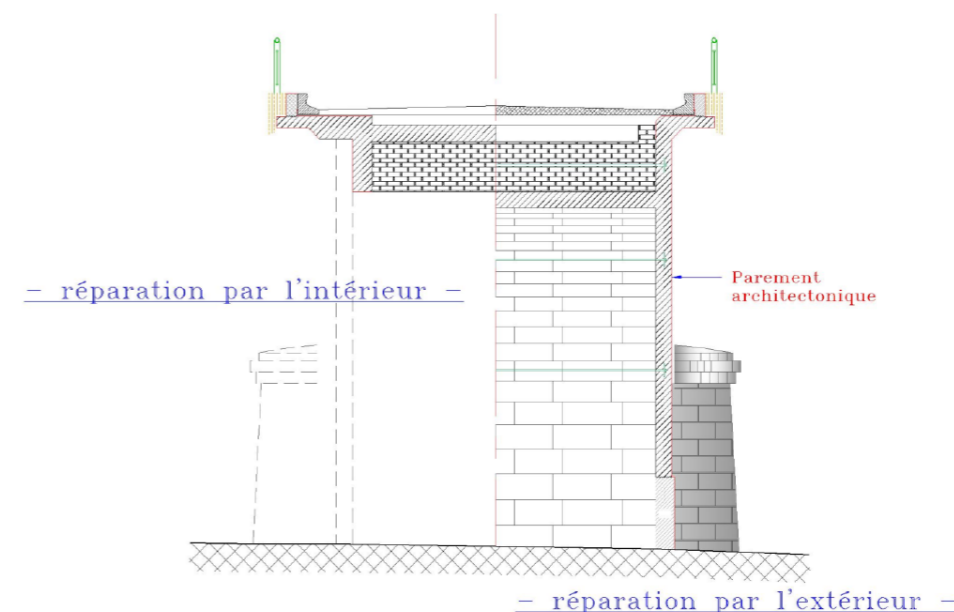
Coupe type de renforcement de l'ouvrage extérieur ou intérieur
